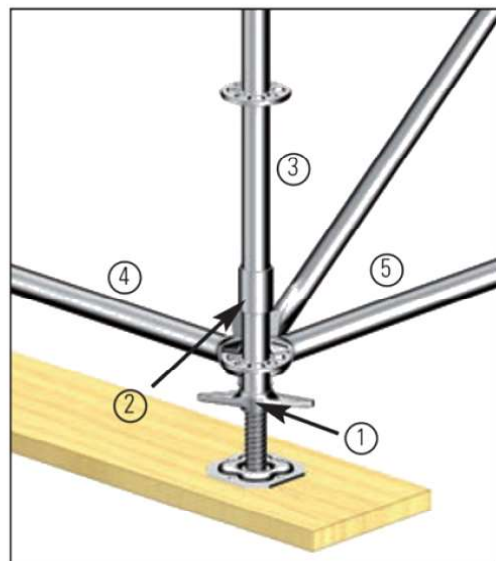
Andamio de fachada. Sistema de Andamios Allround. (2013). Layher, p. 12.
